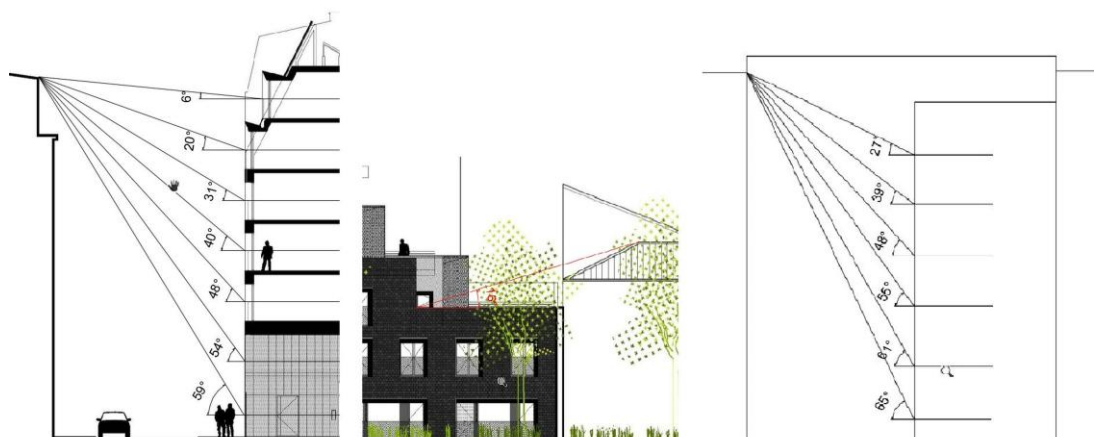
Secciones de las fachadas principal, viviendas aterrazadas y fachada hacia medianera
